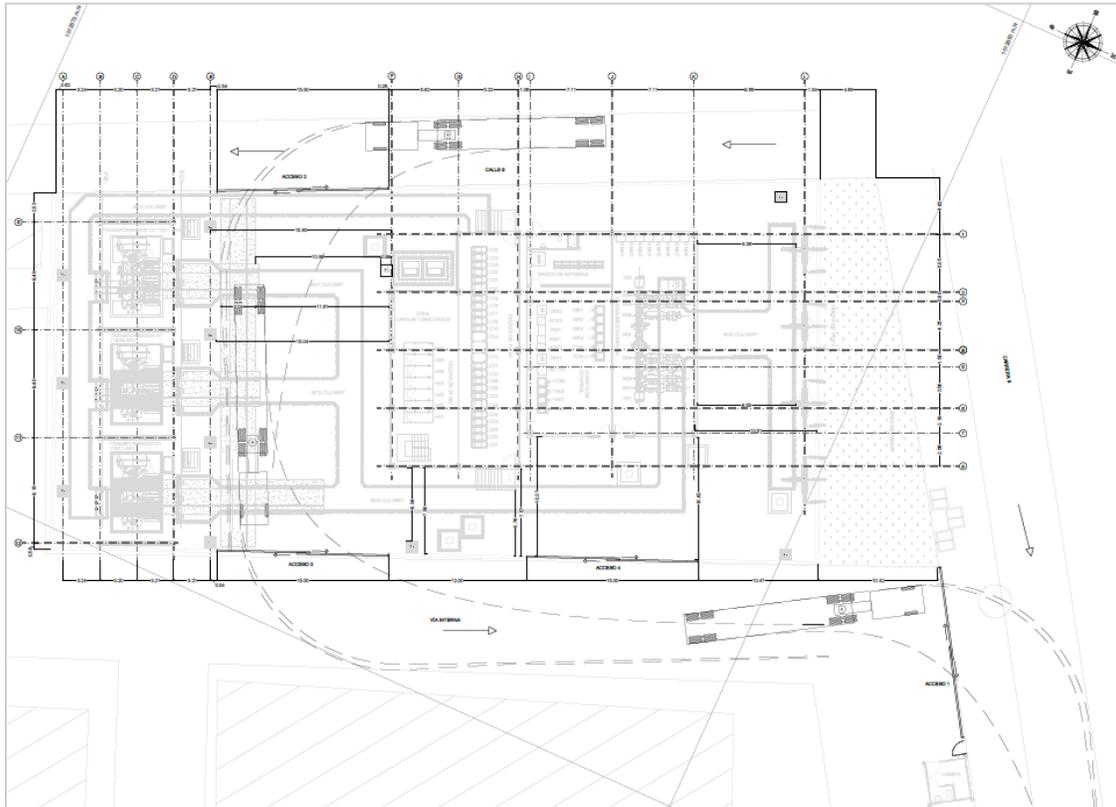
Esquemático de diseño vial dentro de la subestación
